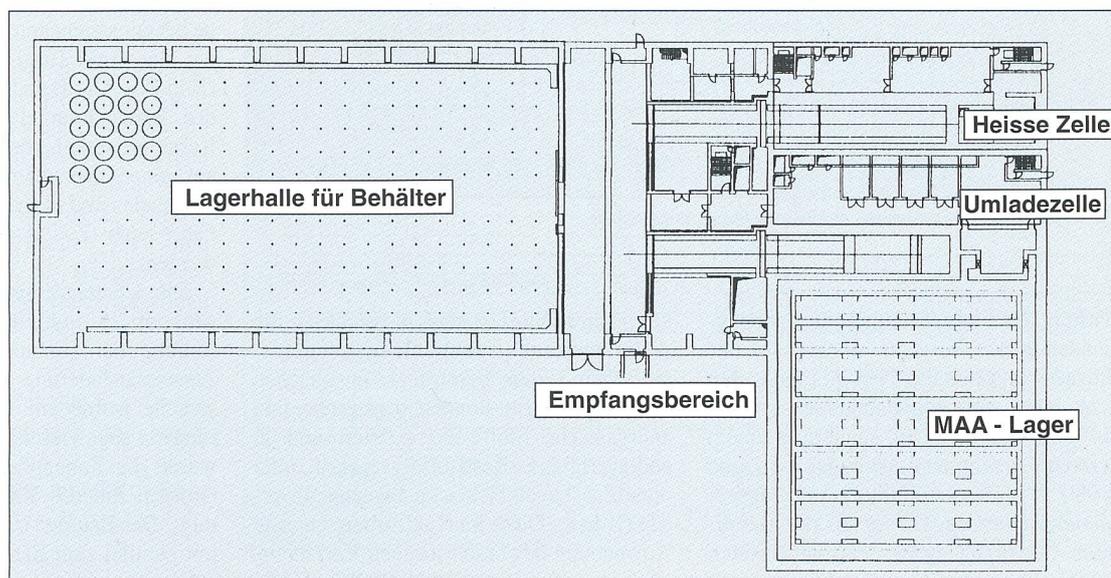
Grundriss von Behälterhalle, Empfangsbereich, Heisser Zelle und Gebäude für mittelaktive Abfälle
